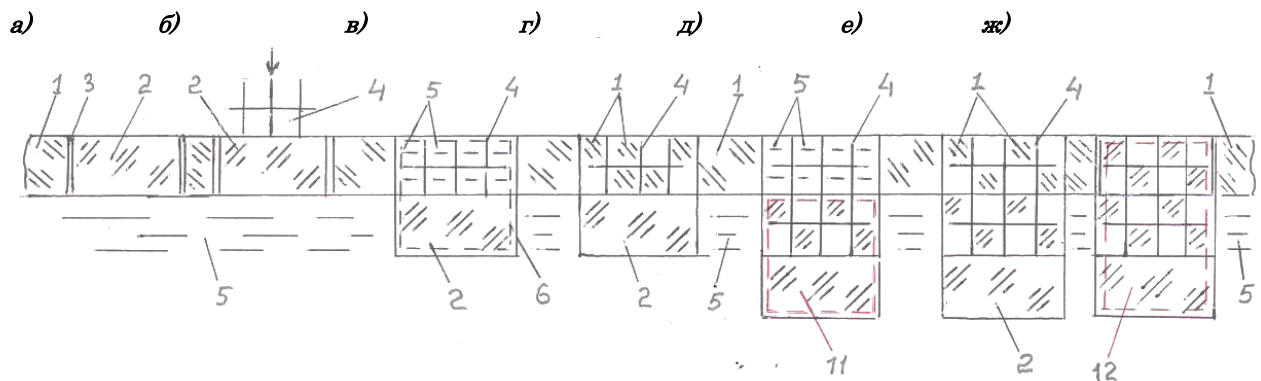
Ледовый покров в разрезе: а – вырезанный базовый ледяной блок; б – базовый ледяной блок с арматурным каркасом; в – притопленная двухслойная секция; г – армированный участок ледового покрова; д – сборный двухслойный армированный ледяной блок; е – участок ледового покрова с двойным армированием; ж – сборный трехслойный армированный ледяной блок
